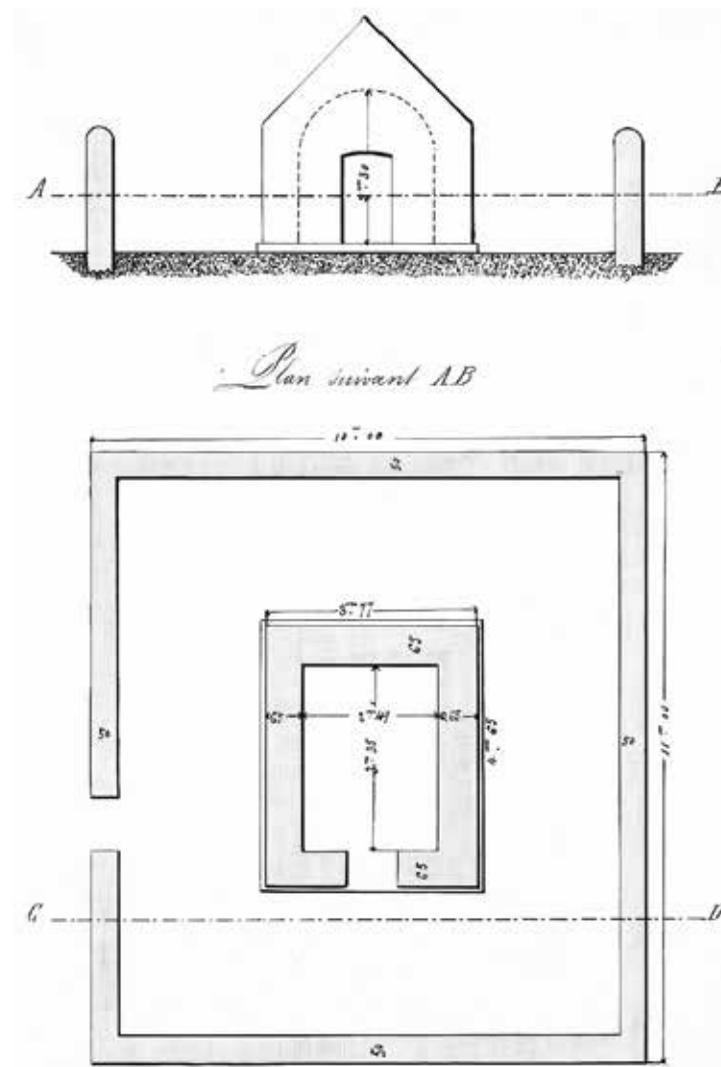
Plan de la poudrière en 1881 (ANOM 23DFC1673).
